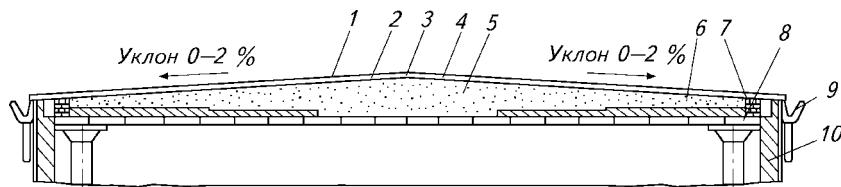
Тепло- и гидроизоляция покрытия холодильника:
